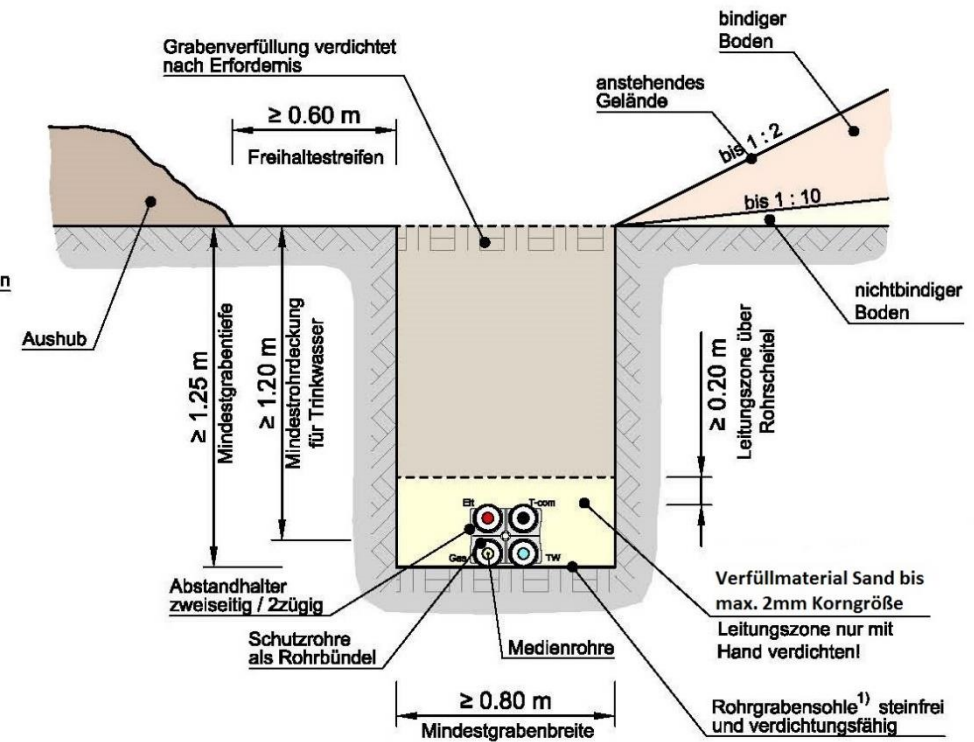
Trinkwasserhausanschlussleitung als Teil einer Mehrspartenverlegung
